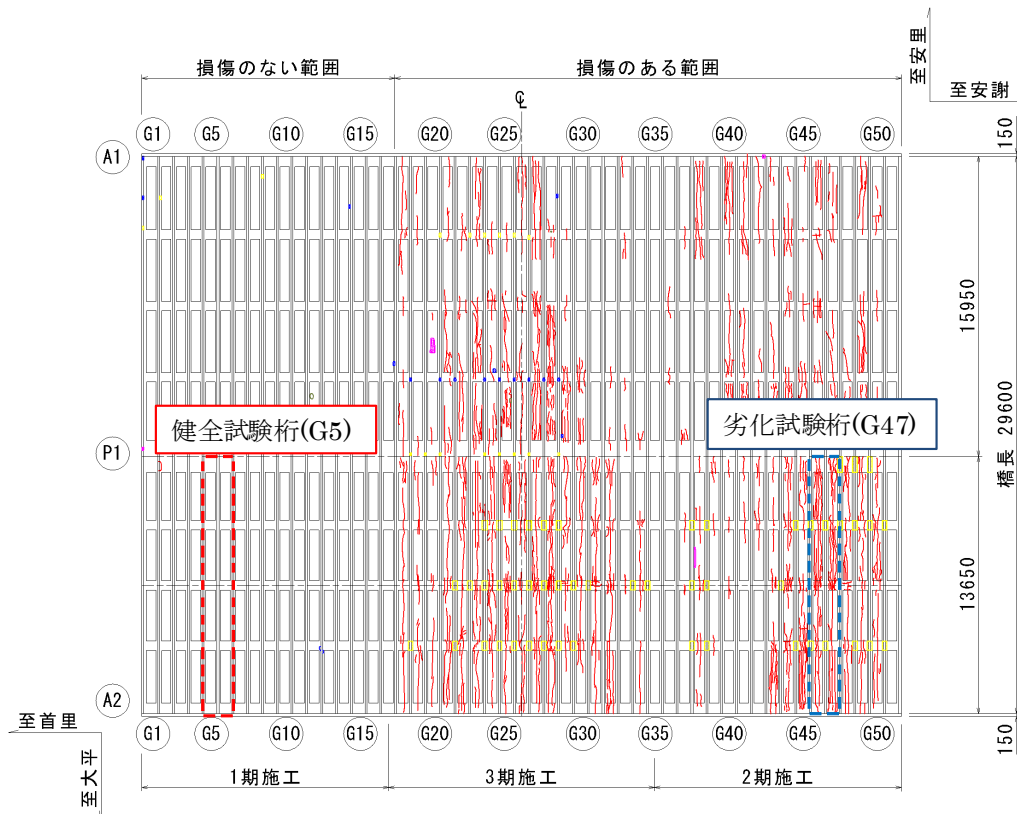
古島橋PC桁下面のひび割れ発生状況 (単位: mm)
